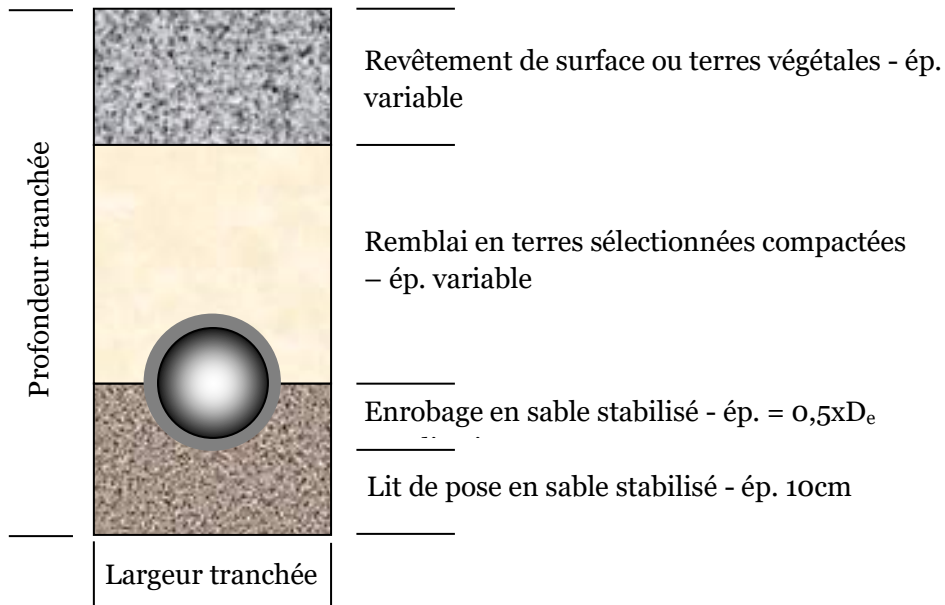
Coupe type pour canalisation de drainage des eaux pluviales
